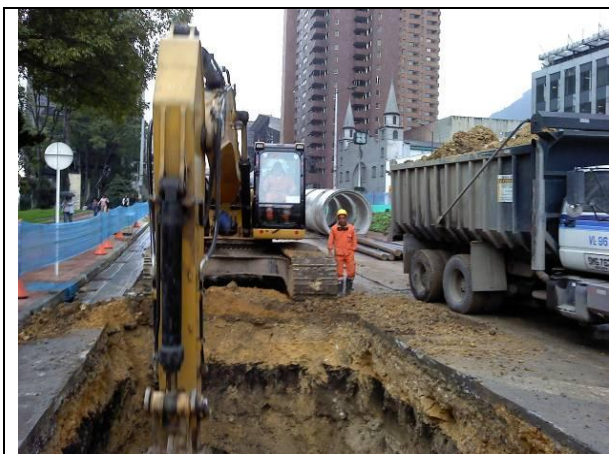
DEMOLICIÓN Y EXCAVACIÓN DE VÍA EXISTENTE
